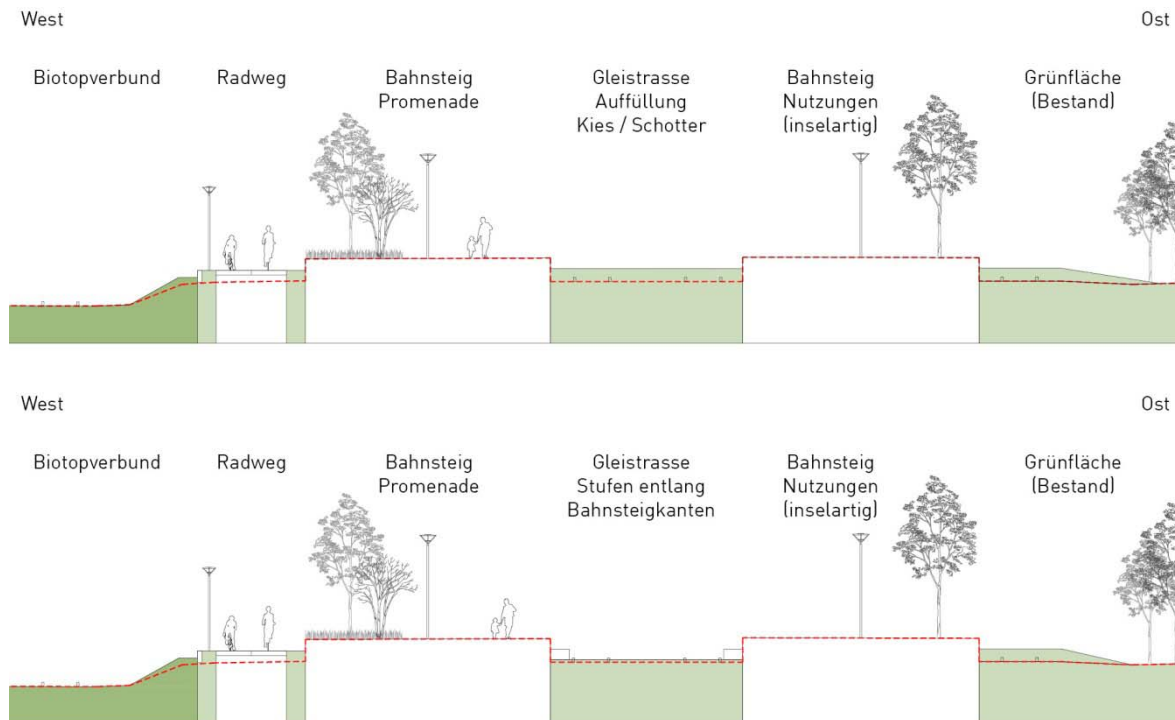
Möglichkeiten zur Absturzsicherung (Verkleinerung, Originalmaßstab Lageplan 1:200)
